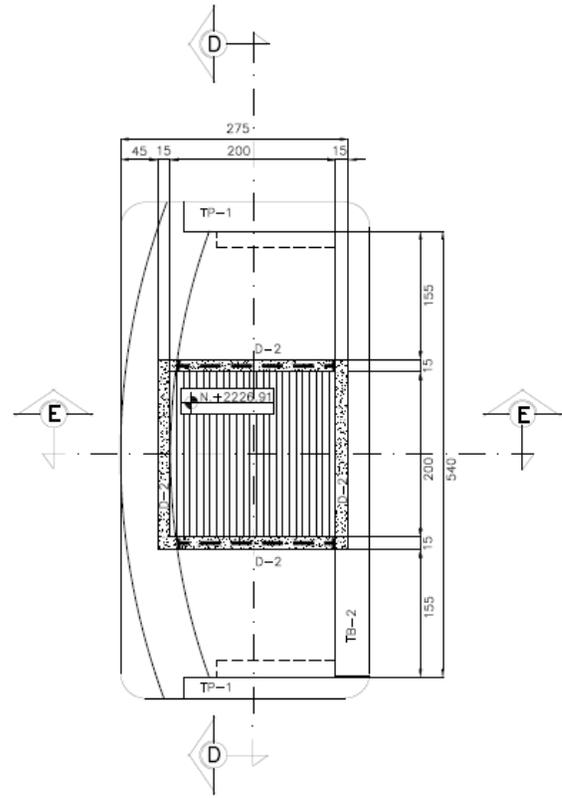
Detalle 4. Pozo de acceso intermedio.
